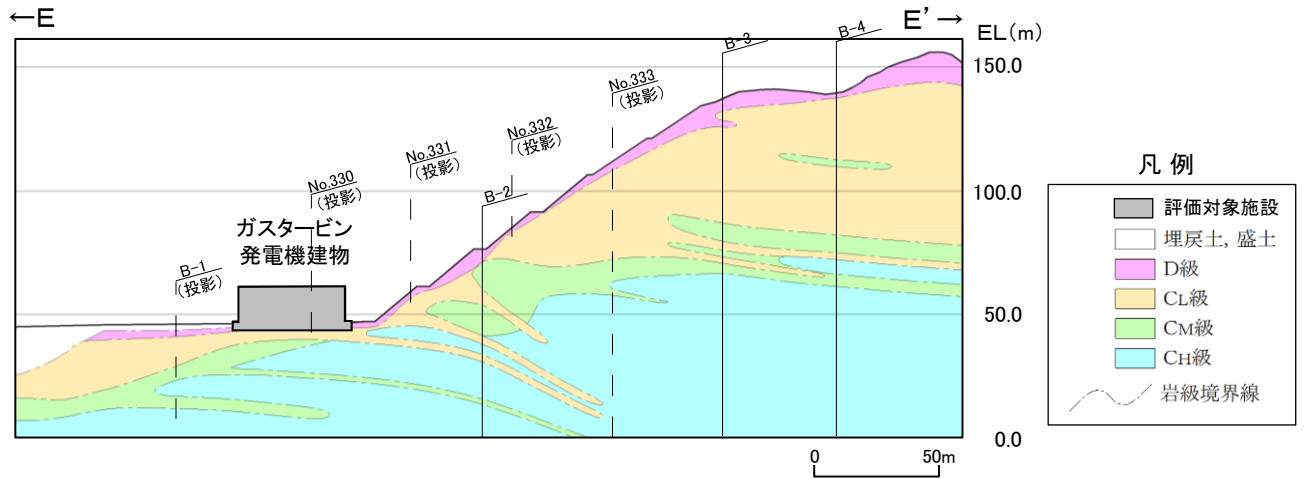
ガスタービン発電機建物の地質断面図 (E-E' 断面)
